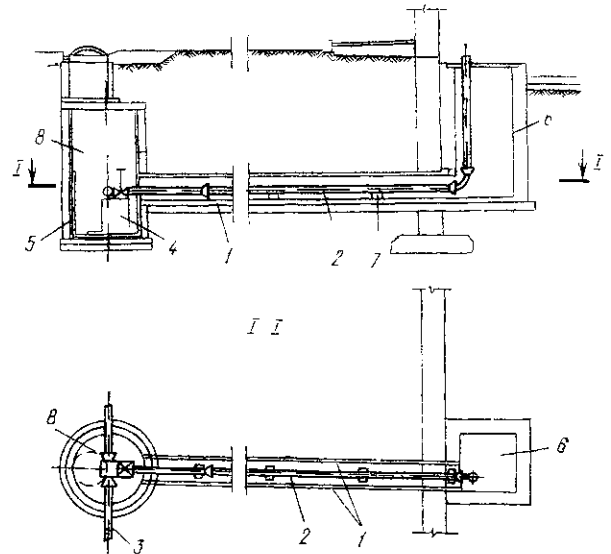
Вариант устройства ввода водопровода в здание при строительстве на просадочных грунтах
